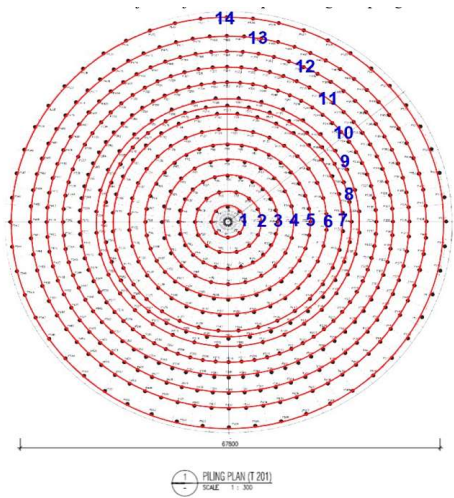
Proses Pemancangan Bagian ke-2 Pondasi Elevated T-201
